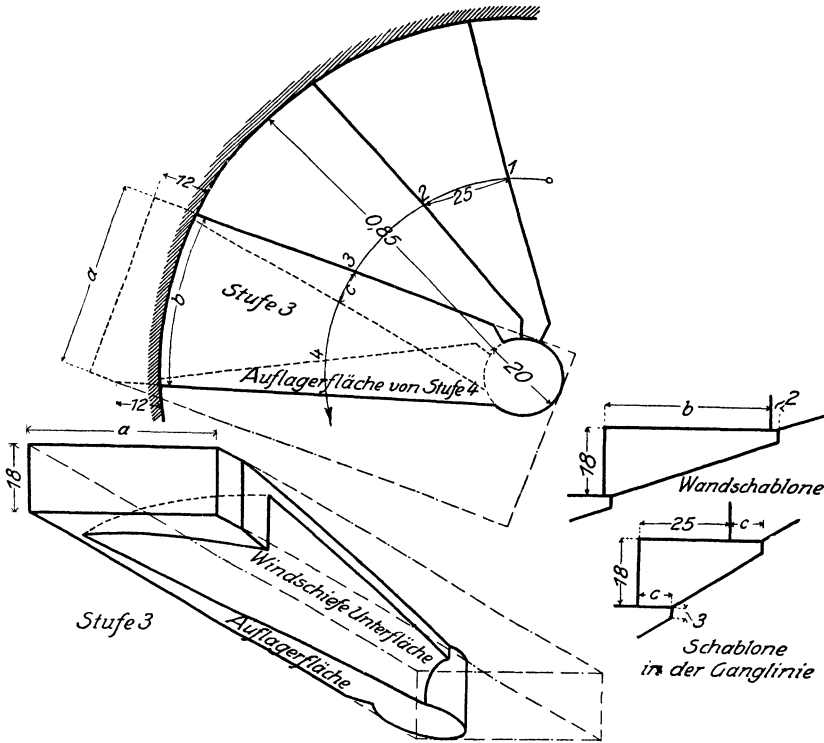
Spindeltreppe mit an die Stufen gearbeiteter Spindel.
